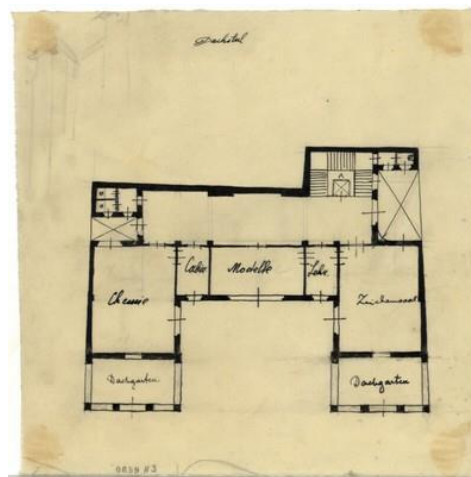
Grundriss des Dachgeschoßes der SCHWARZWALDSCHULE Wien I, Wallnerstraße 9, Tuschezeichnung auf Papier von Adolf Loos, datiert 1912-1914. 194 x 191 mm. Provenienz: Erben nach Ludwig Münz (Quelle: ALBERTINA MUSEUM WIEN Inv.- Nr. ALA 659).
